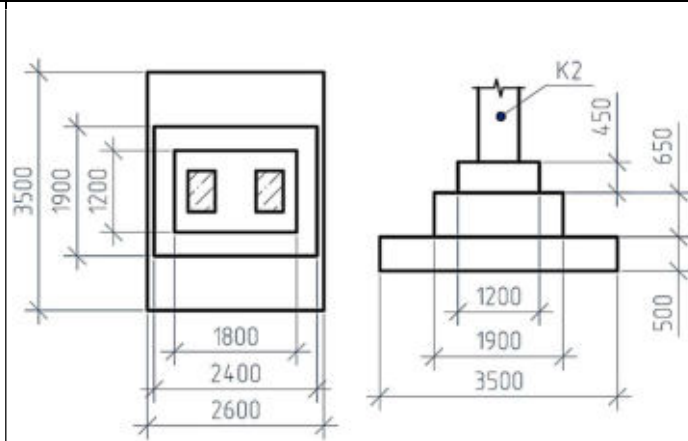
Общий вид конструкции фундамента в/о 8-9/А
